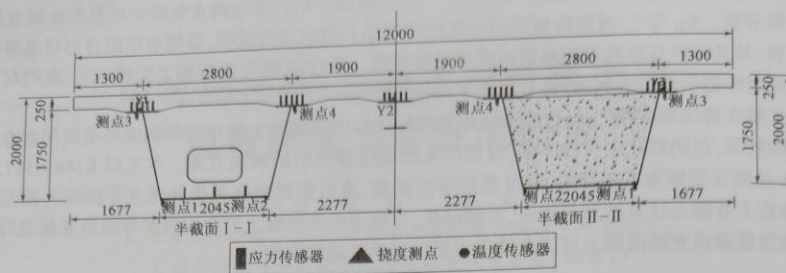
K146+177.763 阜城村 G211 分离立交横断面图(尺寸单位:mm)
